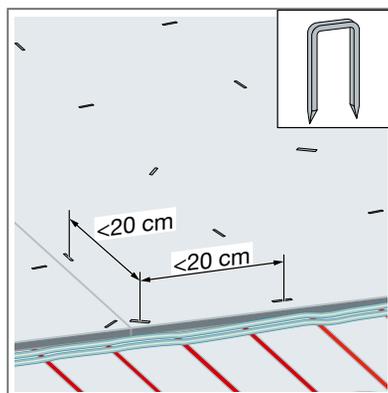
Gipsfaserausbauplatten mit Spreizklammern befestigen
